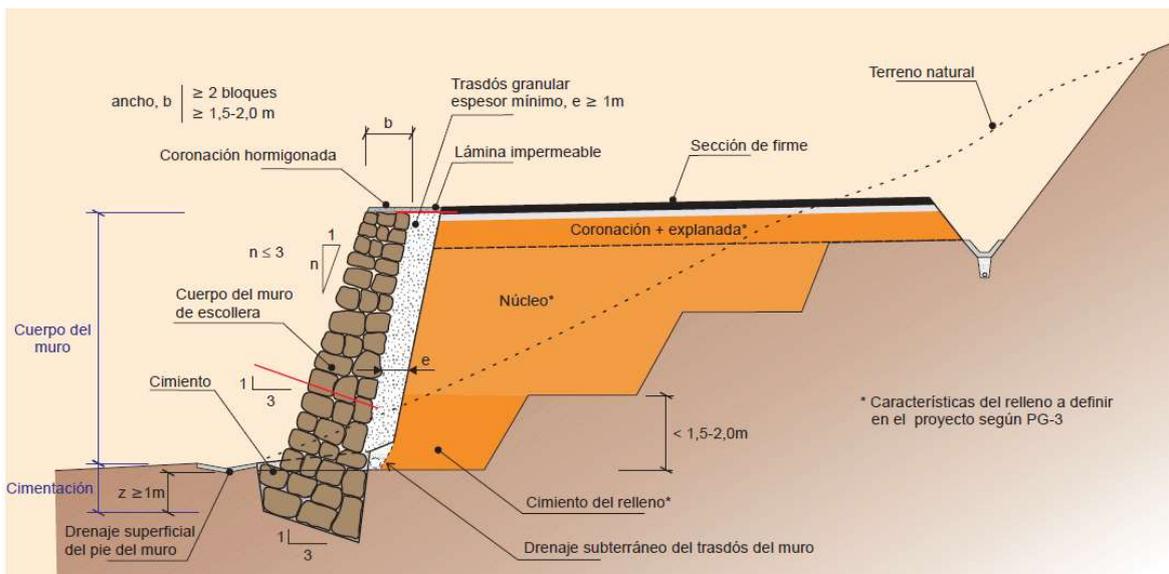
Sección geométrica de un muro de escollera de sostenimiento (DGC)
